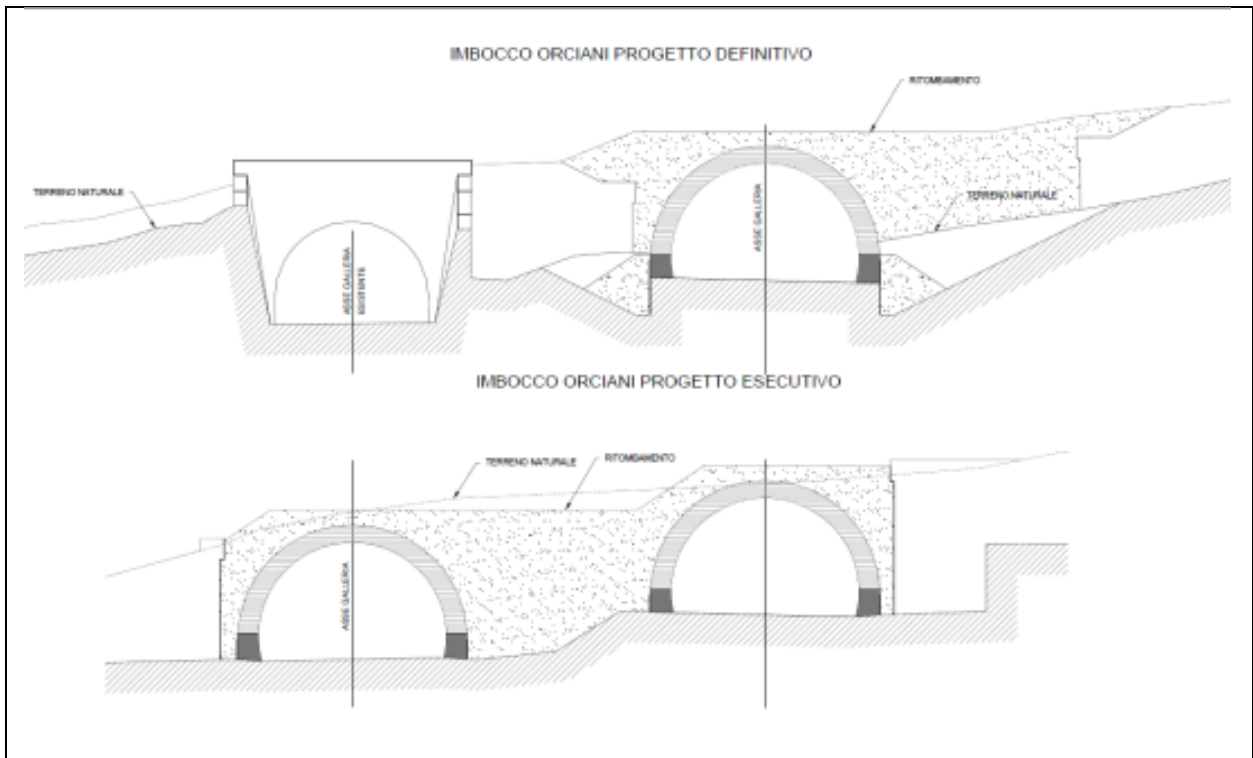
Confronto imbocco Orciani tra progetto definitivo e progetto esecutivo
